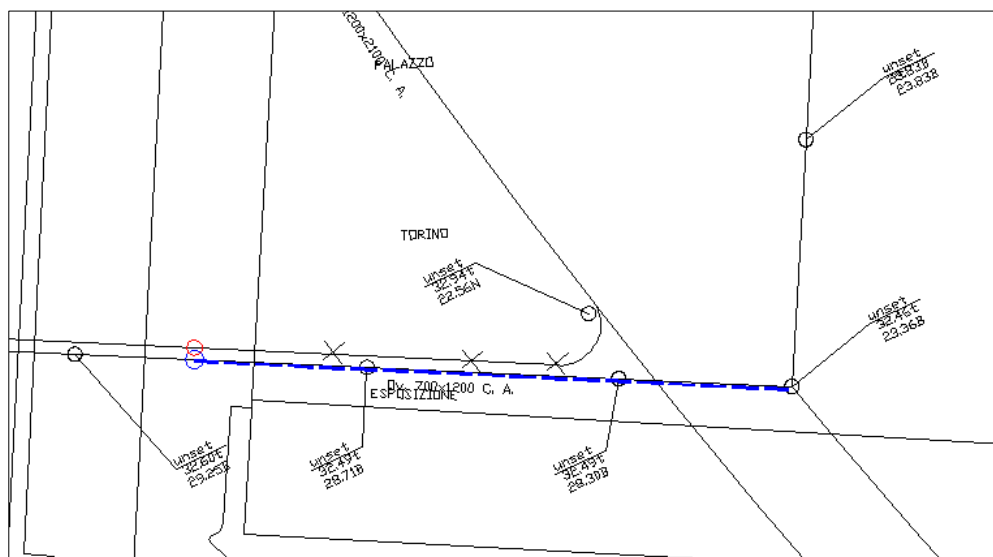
Planimetria rete fognaria – bianca interferente: proposta di risoluzione
